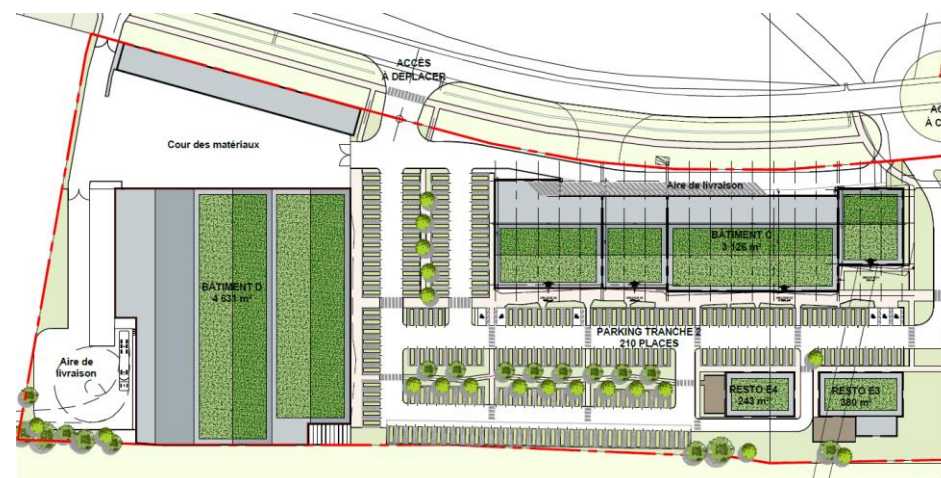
Plan de masse - phase 2 de la zone commerciale (Source : Artchimad, Avril 2022)
